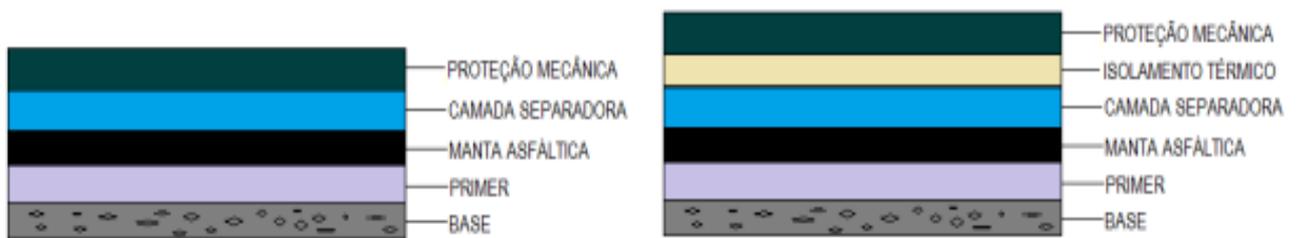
Etapas e camadas em impermeabilização em manta asfáltica (JOFFILY, 2013).
